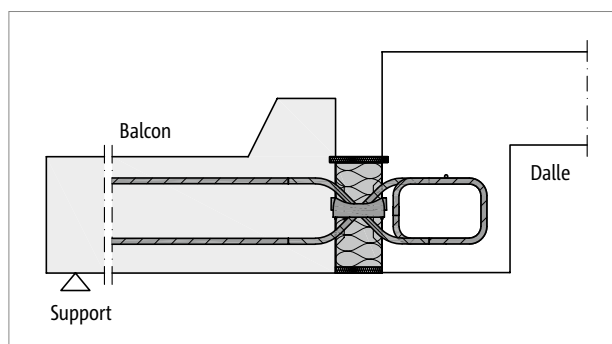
Schöck Isokorb® T Type Q-E-W-VV : Cas d'installation « dalle de balcon préfabriquée »
